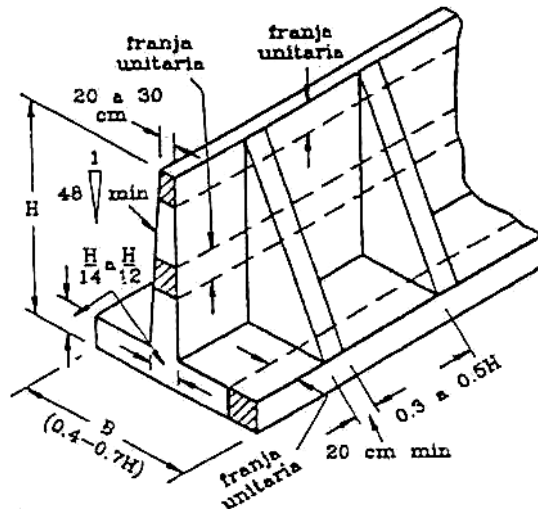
Predimensionamiento para un muro con contrafuertes
